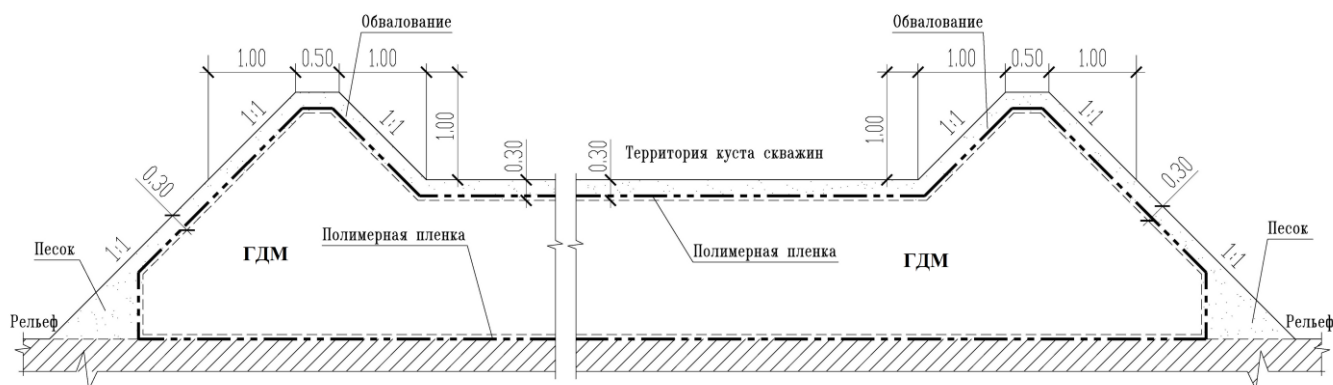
Гидроизоляция оснований кустовых площадок ГДМ
